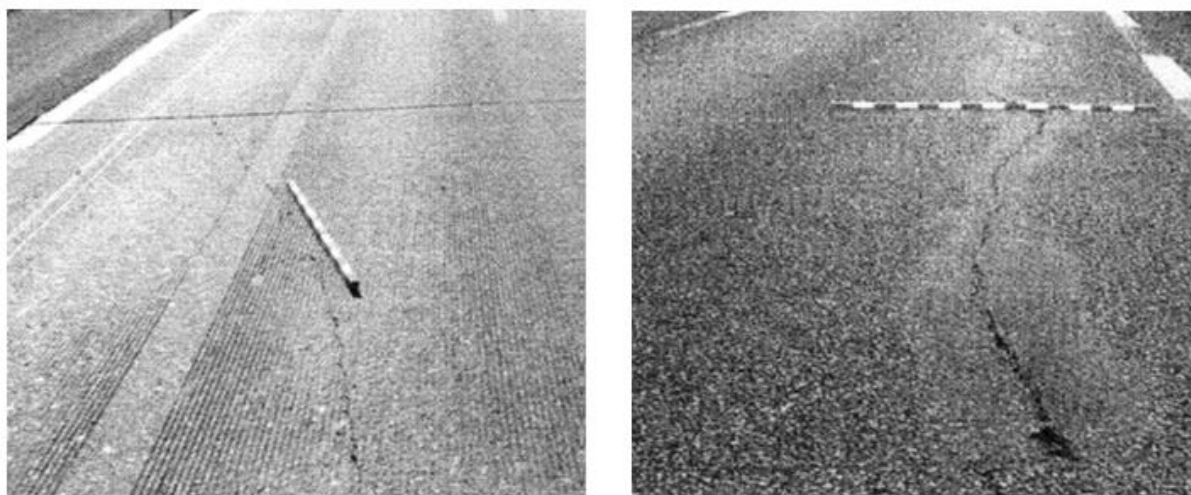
Fissure longitudinale d'une chaussée rigide
